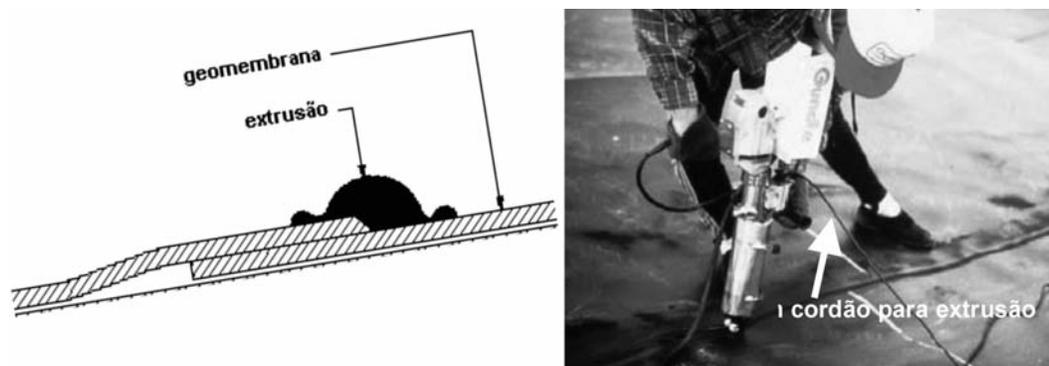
Soldadura por extrusão (Kavazanjian & Cooley 2001).
